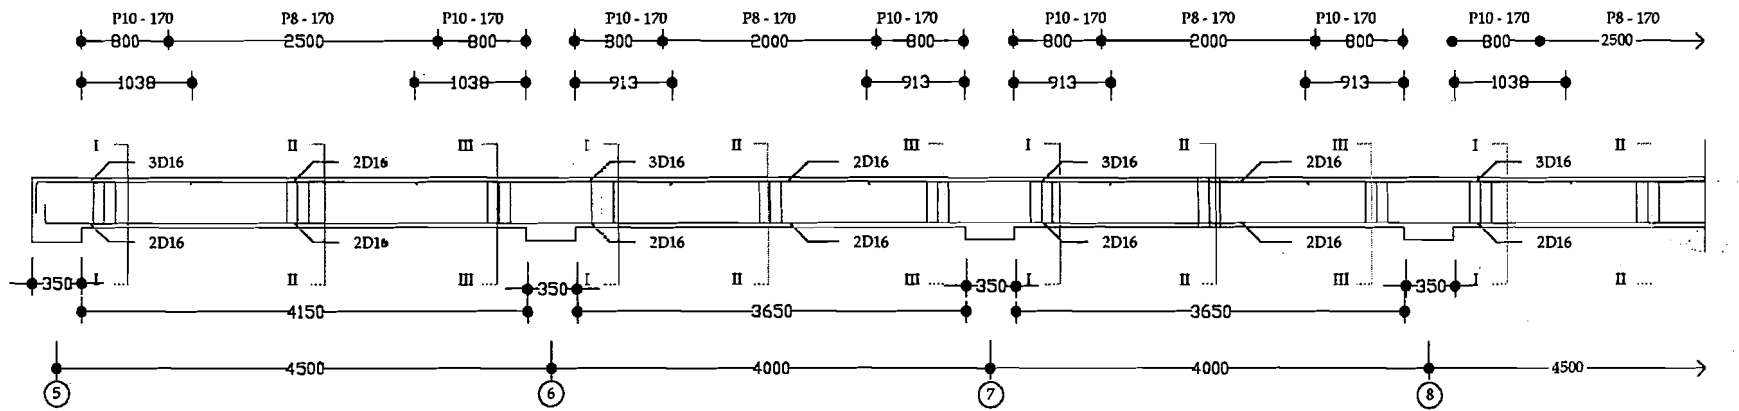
Denah Rencana Balok Anak Lantai 1
